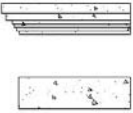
Beton esaslı prekast cephe panellerinde biçimsel farklılıklar.
